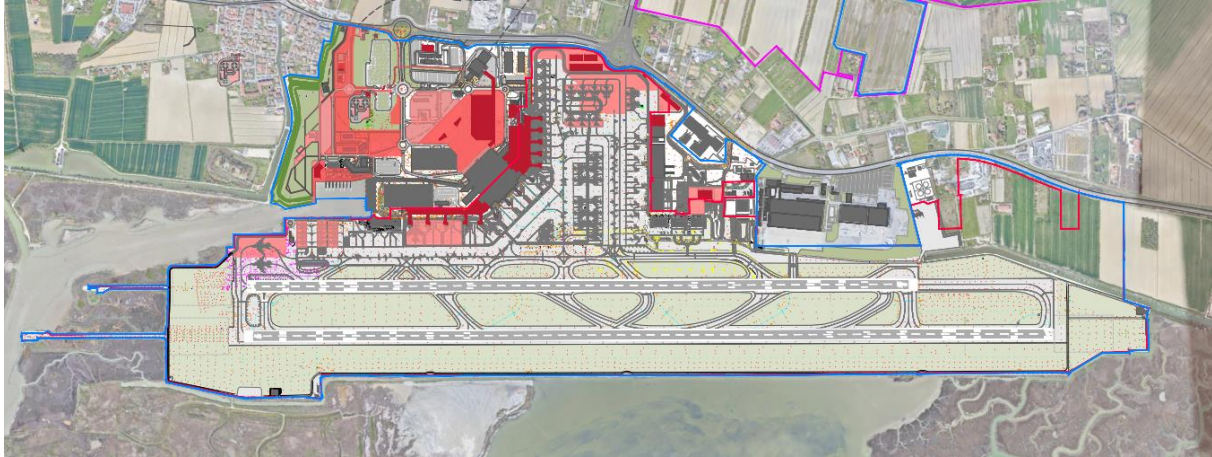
Aggiornamento Masterplan – Fase 2 – 2033 (Estratto SIA)
